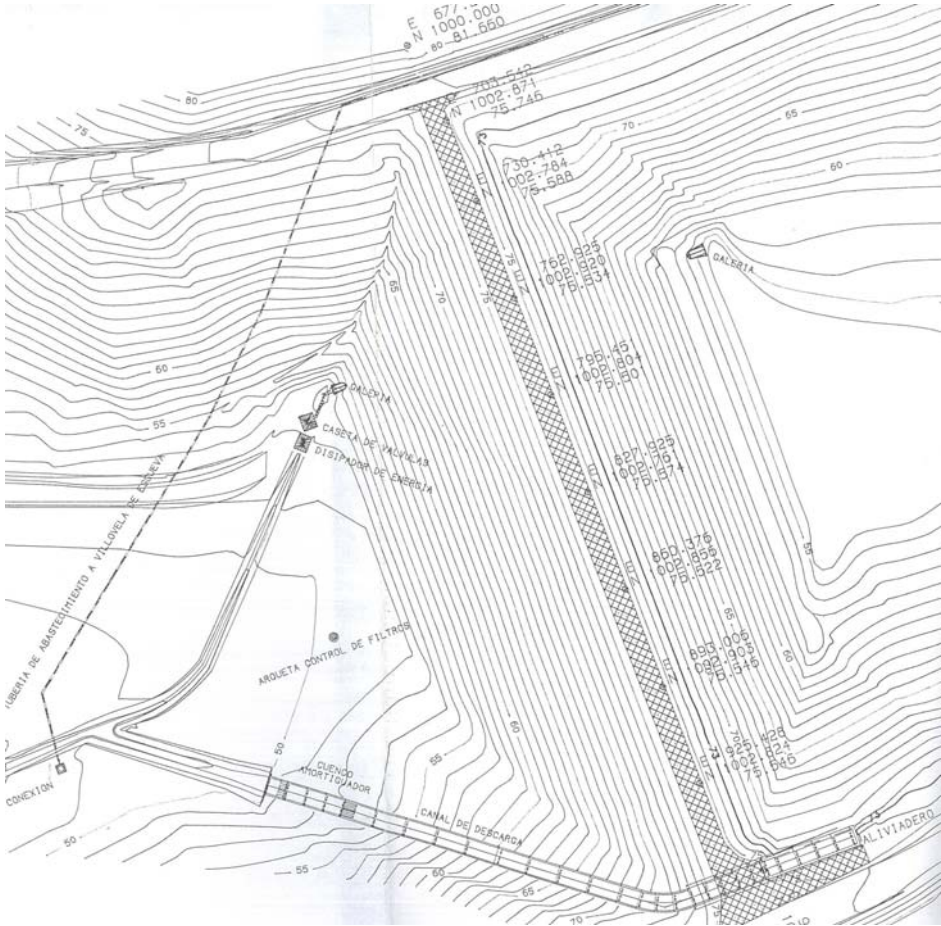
Plano de planta de la presa de Tórtoles de Esgueva
